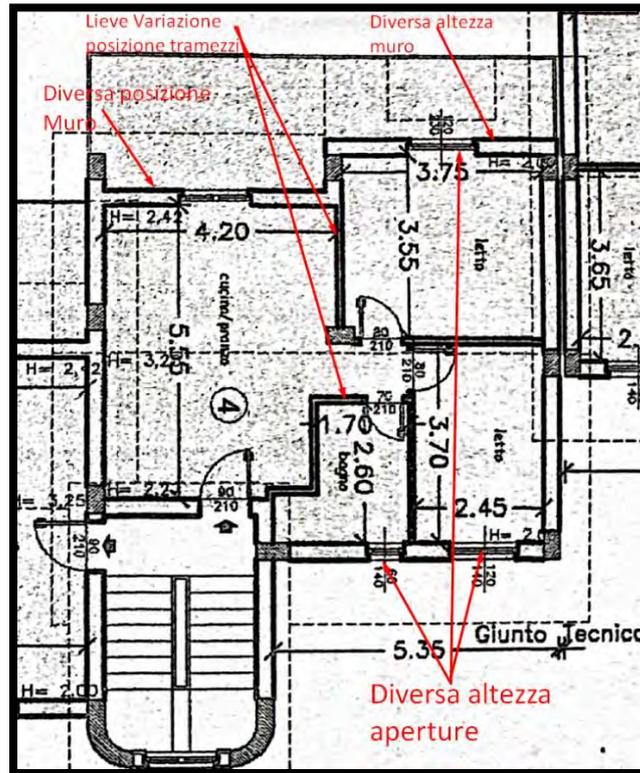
Pianta piano terzo allegata al Permesso a costruire n. 5 del 19/04/2011
